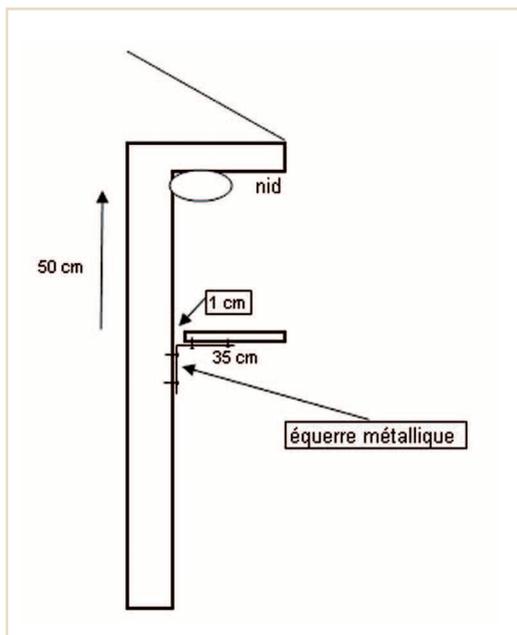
Comment bien placer une planchette anti-fiente / The recommended way of installing a droppings protection board
